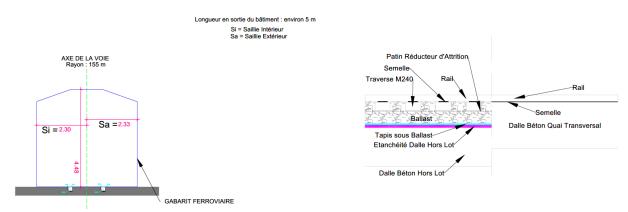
Coupe-type voie béton en dehors du bâtiment (source : ARTELIA)
